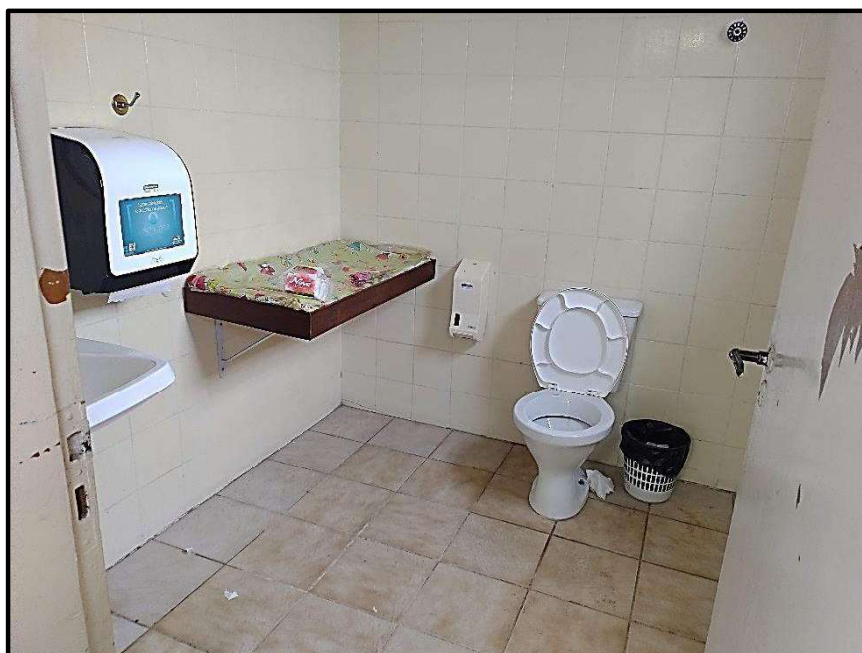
Aspecto interno de banheiro no pavimento superior.
